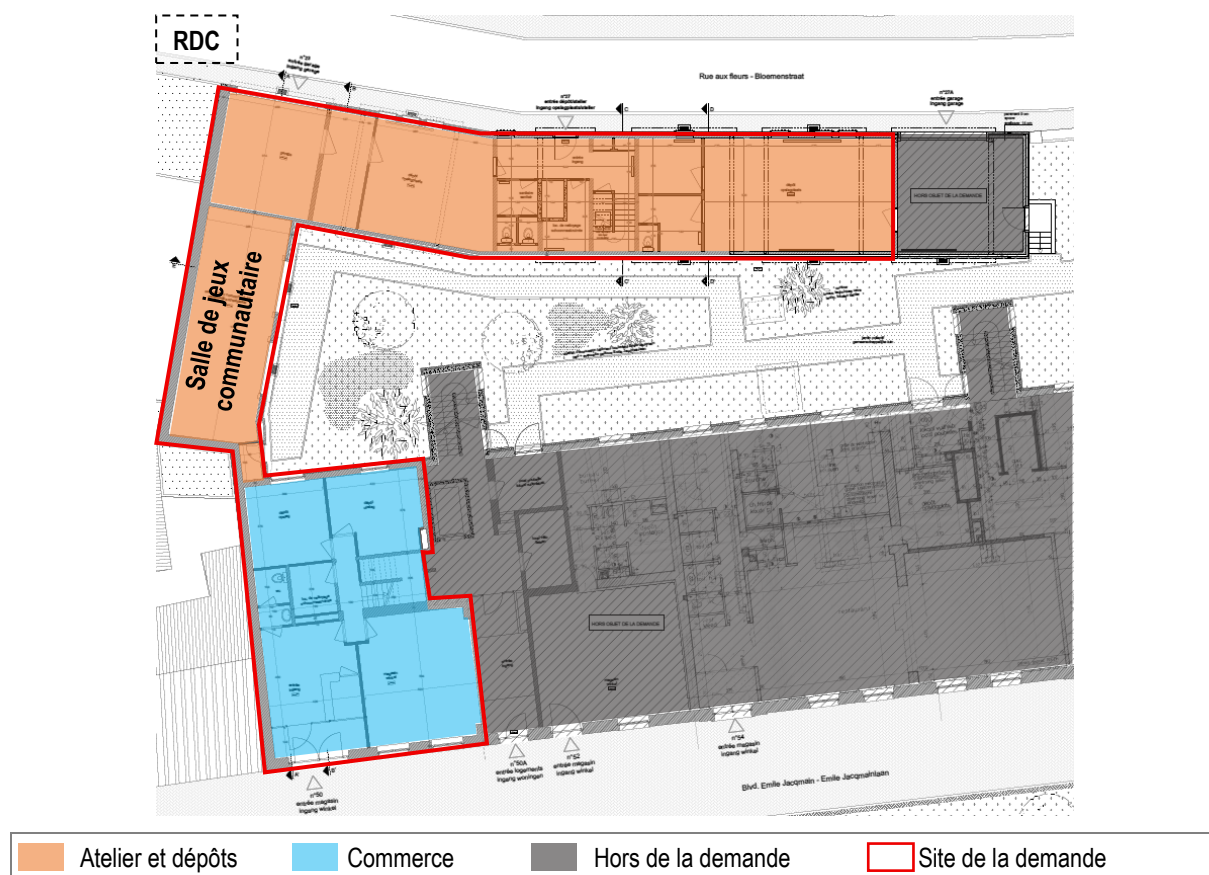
Affectations existantes, niveau rez-de-chaussée (ARIES sur fond de plan Ville de Bruxelles, 2025)
